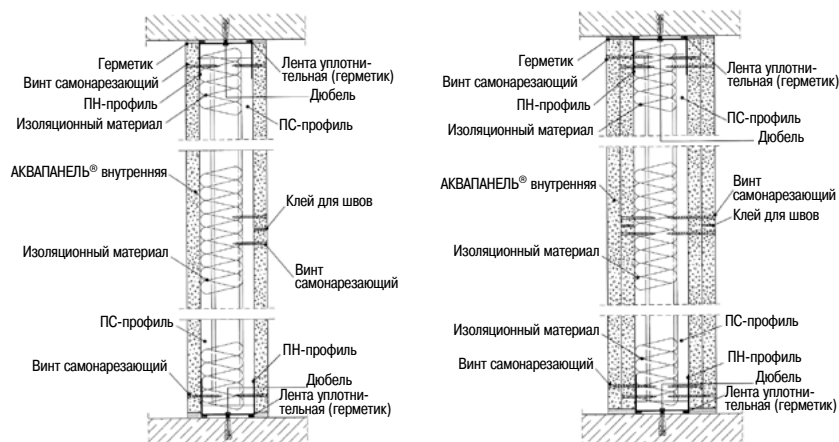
Типы внутренних стен: а – однослойная перегородка; б – двухслойная перегородка
